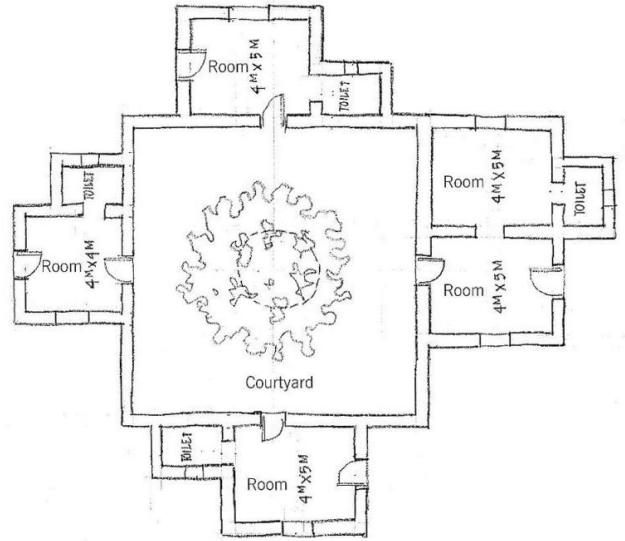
Plano de planta baja. Proyecto en Mehrauli
